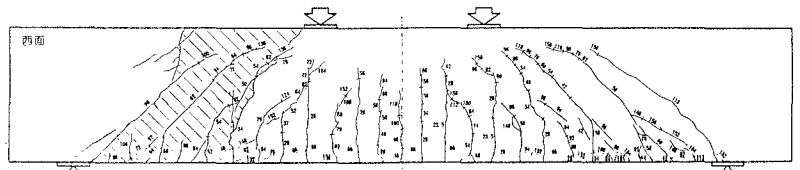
(1) 梁①試験体のひび割れ性状図
